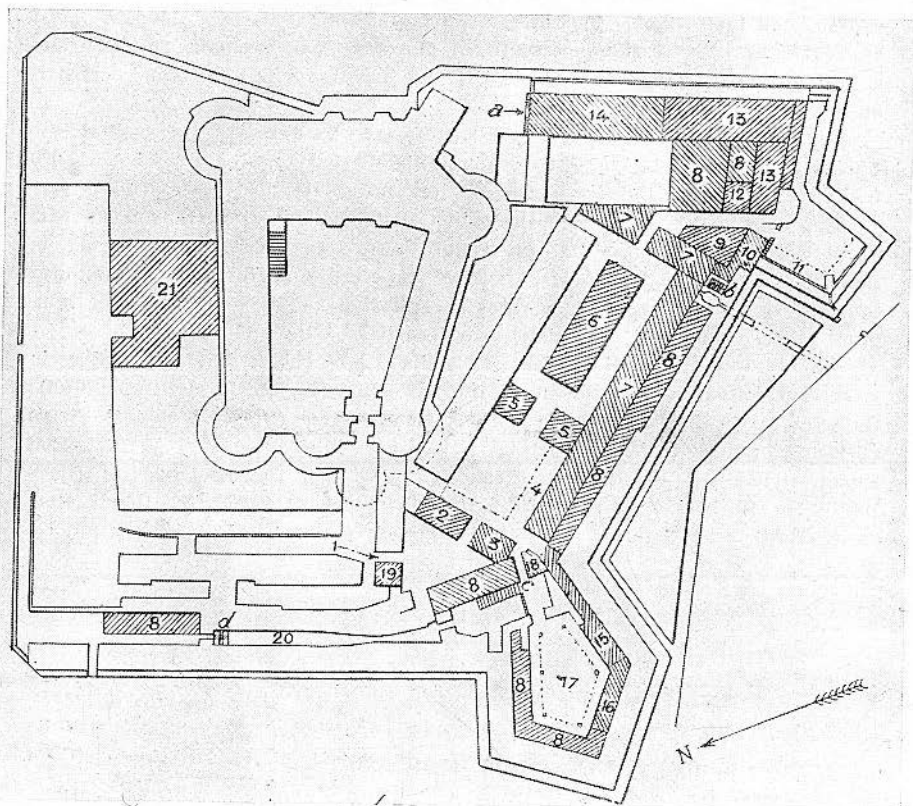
Pianta di Castel-Nuovo e dell'Arsenale di Napoli nell'anno 1875.
